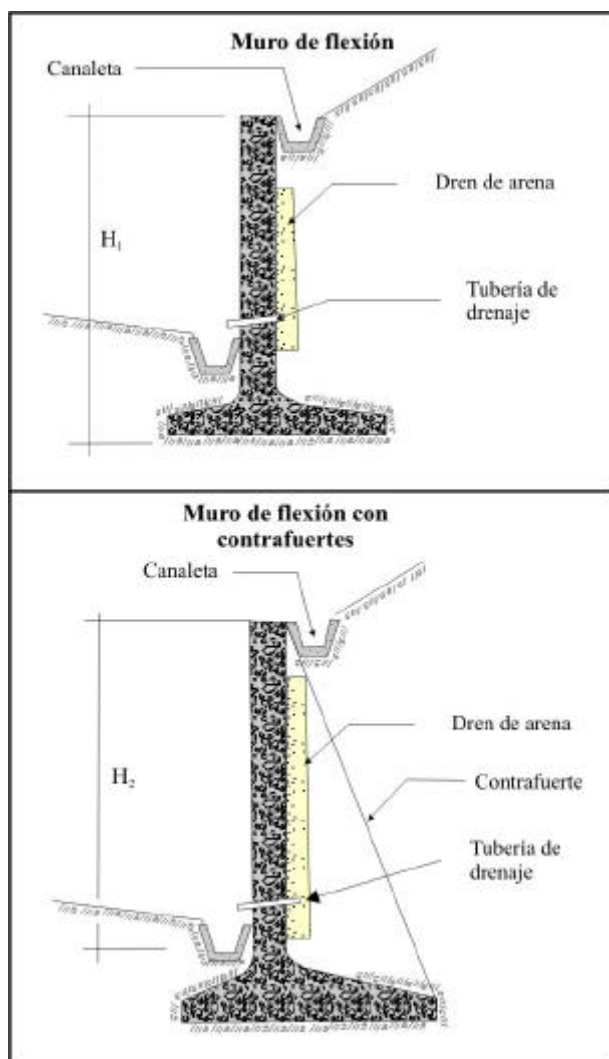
Muros de concreto armado tipo flexión (tomado de INGEMMET, 2000).
